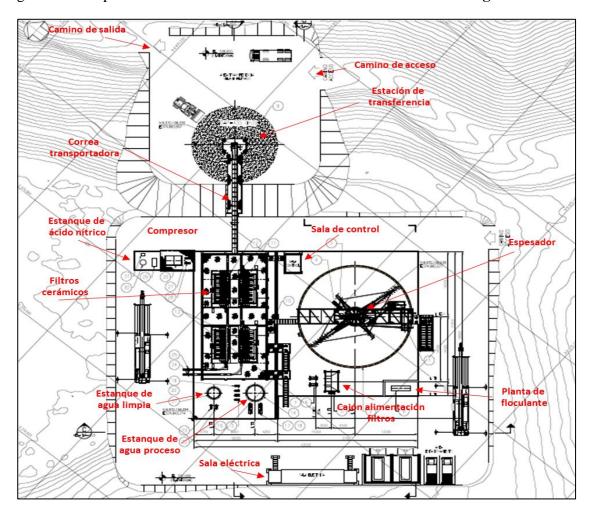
Planta de relaves filtrados. Fuente Atacama Kozan.
